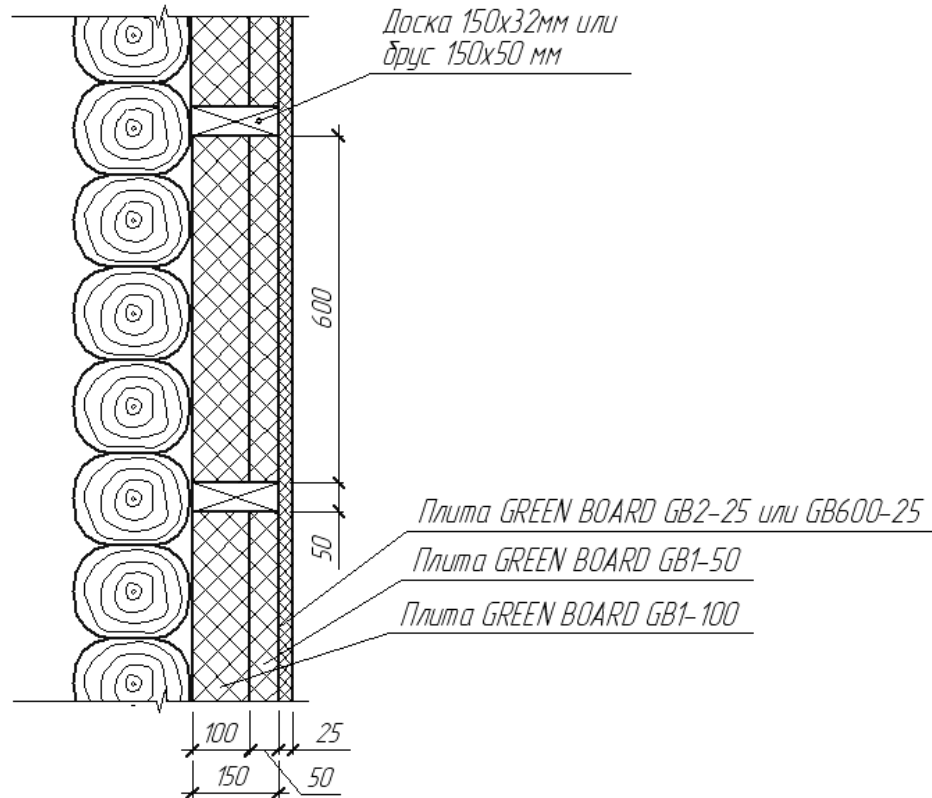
Разрез деревянной стены с утеплителем и внутренней обшивкой
